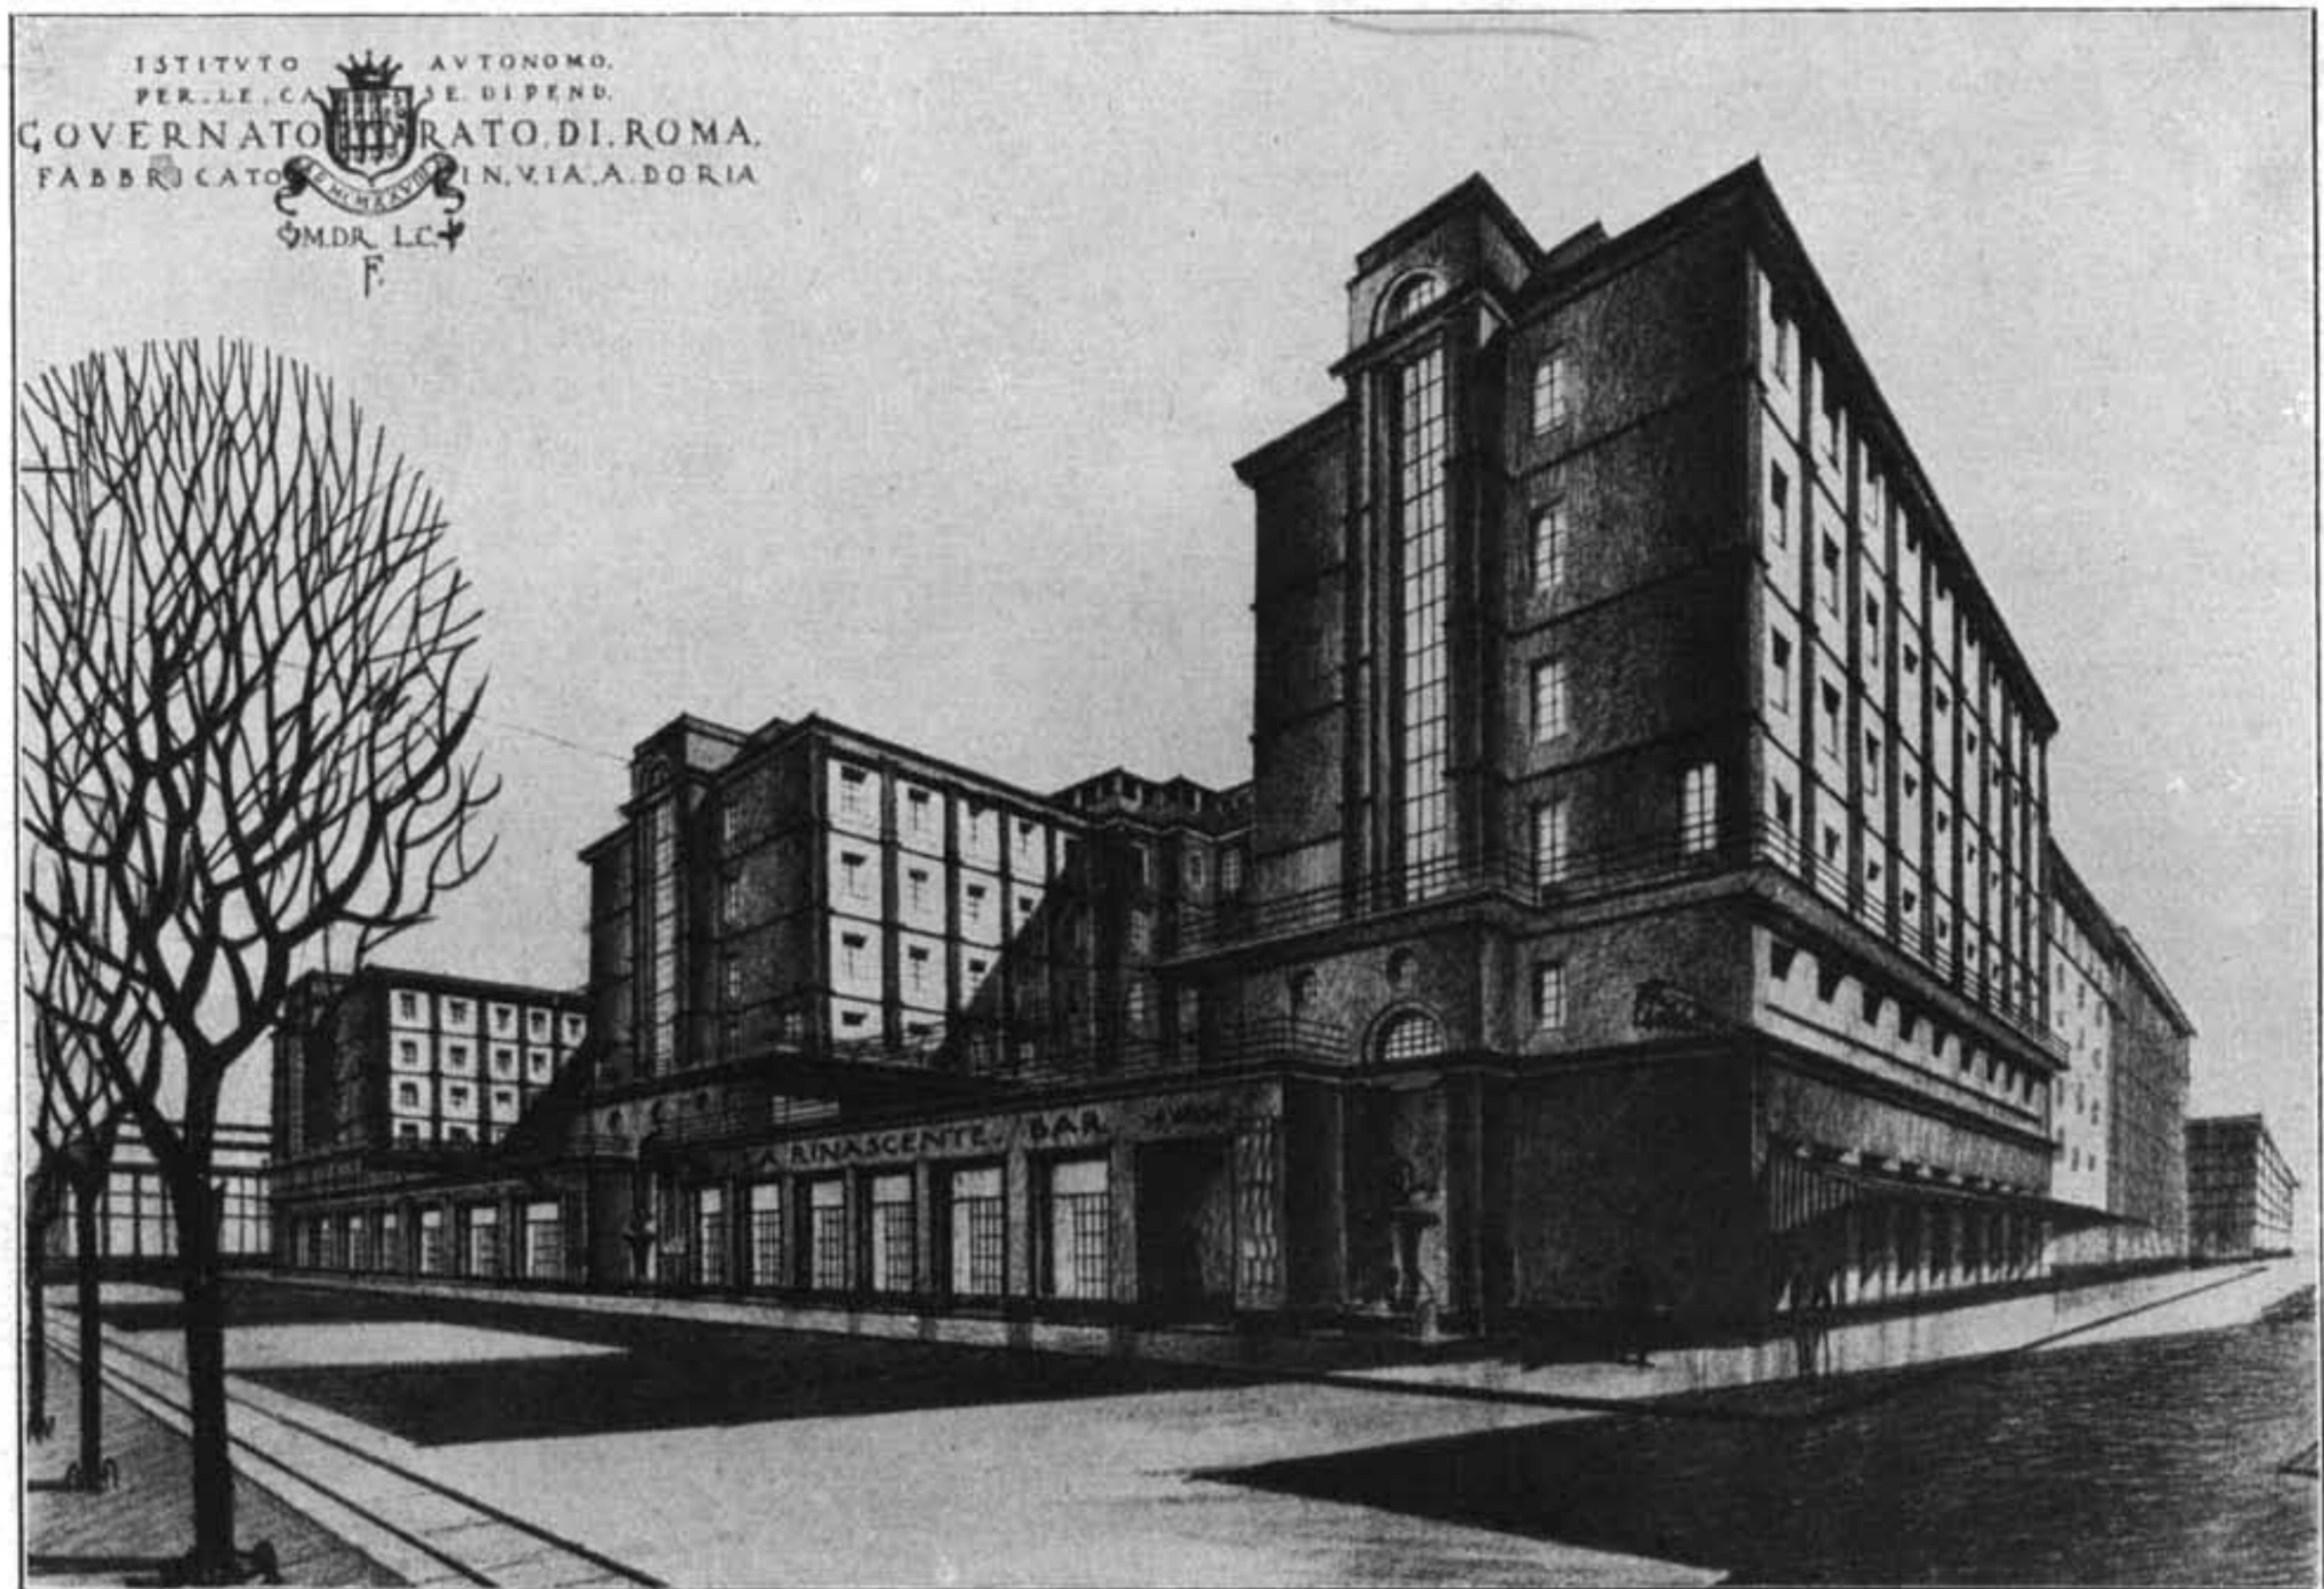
VEDUTA PROSPETTICA DI UN SECONDO PROGETTO ELABORATO SULLA PIANTA ILLUSTRATA ALLA FIG. 4.
